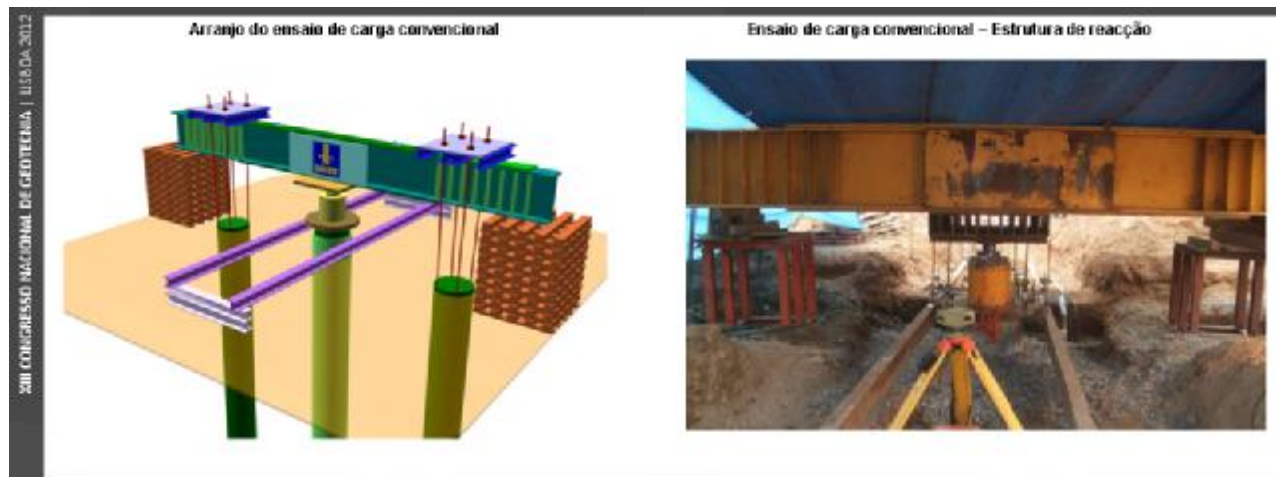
Arranjo do ensaio de carga convencional. Estrutura de reacção do ensaio.
